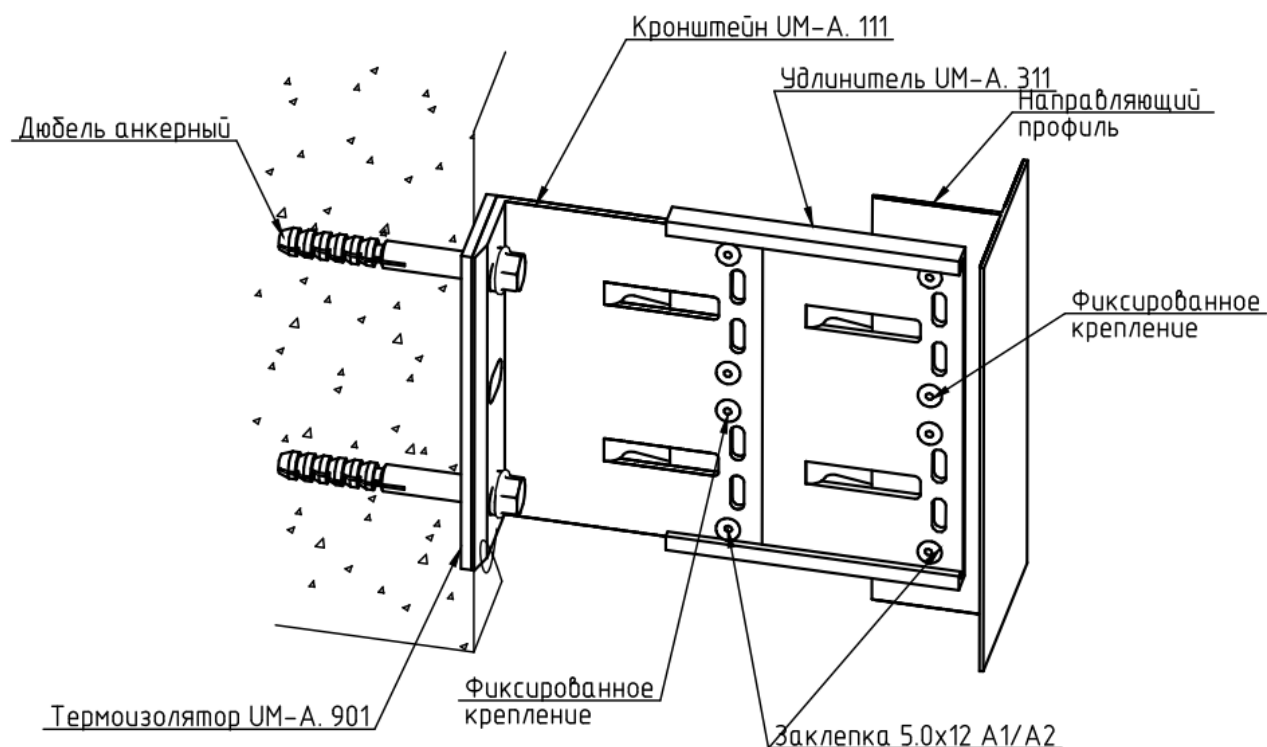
Схема сборки несущего узла с использованием удлинителя
